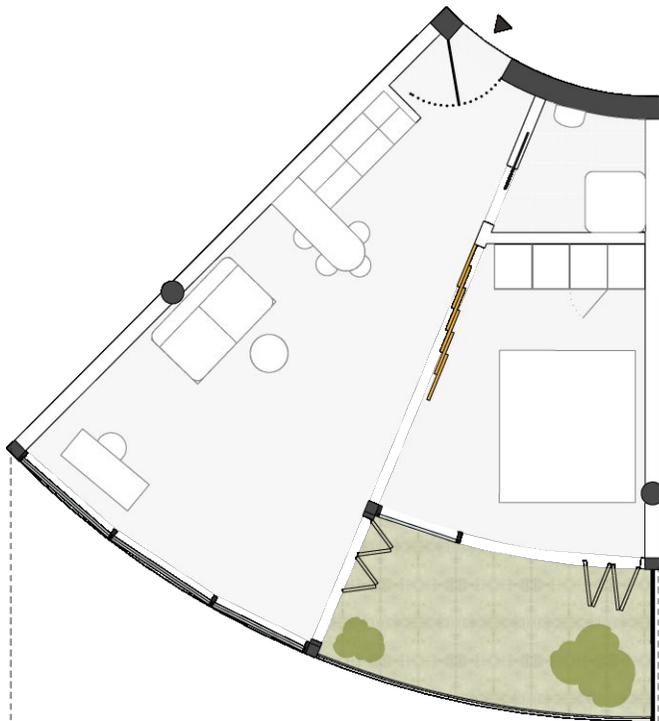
Grundriss Wohnung Typ A.b, halboffen
